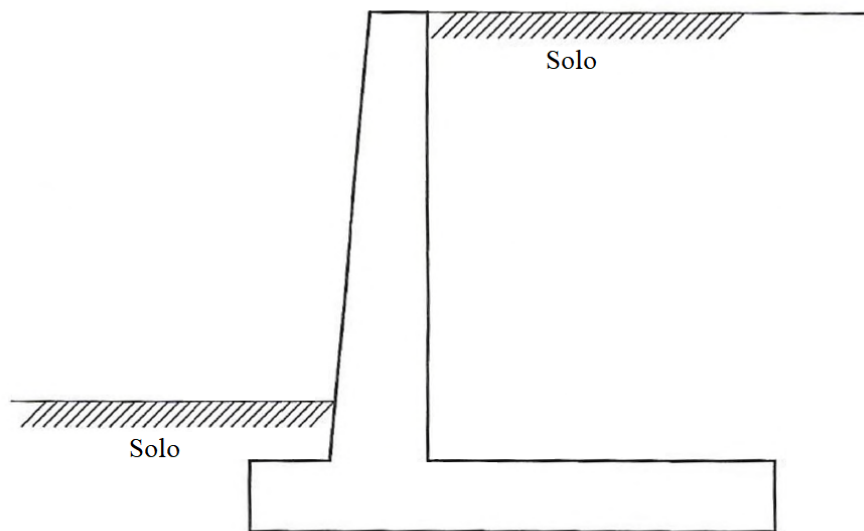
Muro de flexão (modificado - Marchetti, 2007).
